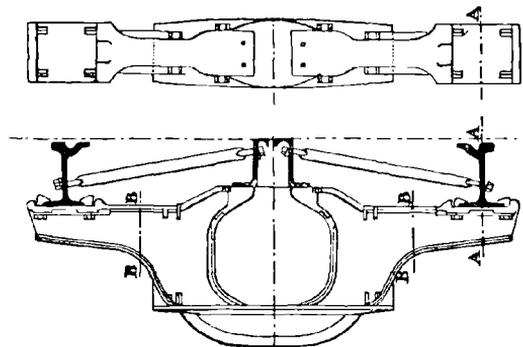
Caniveau de la Metropolitan Street Railway Co.
